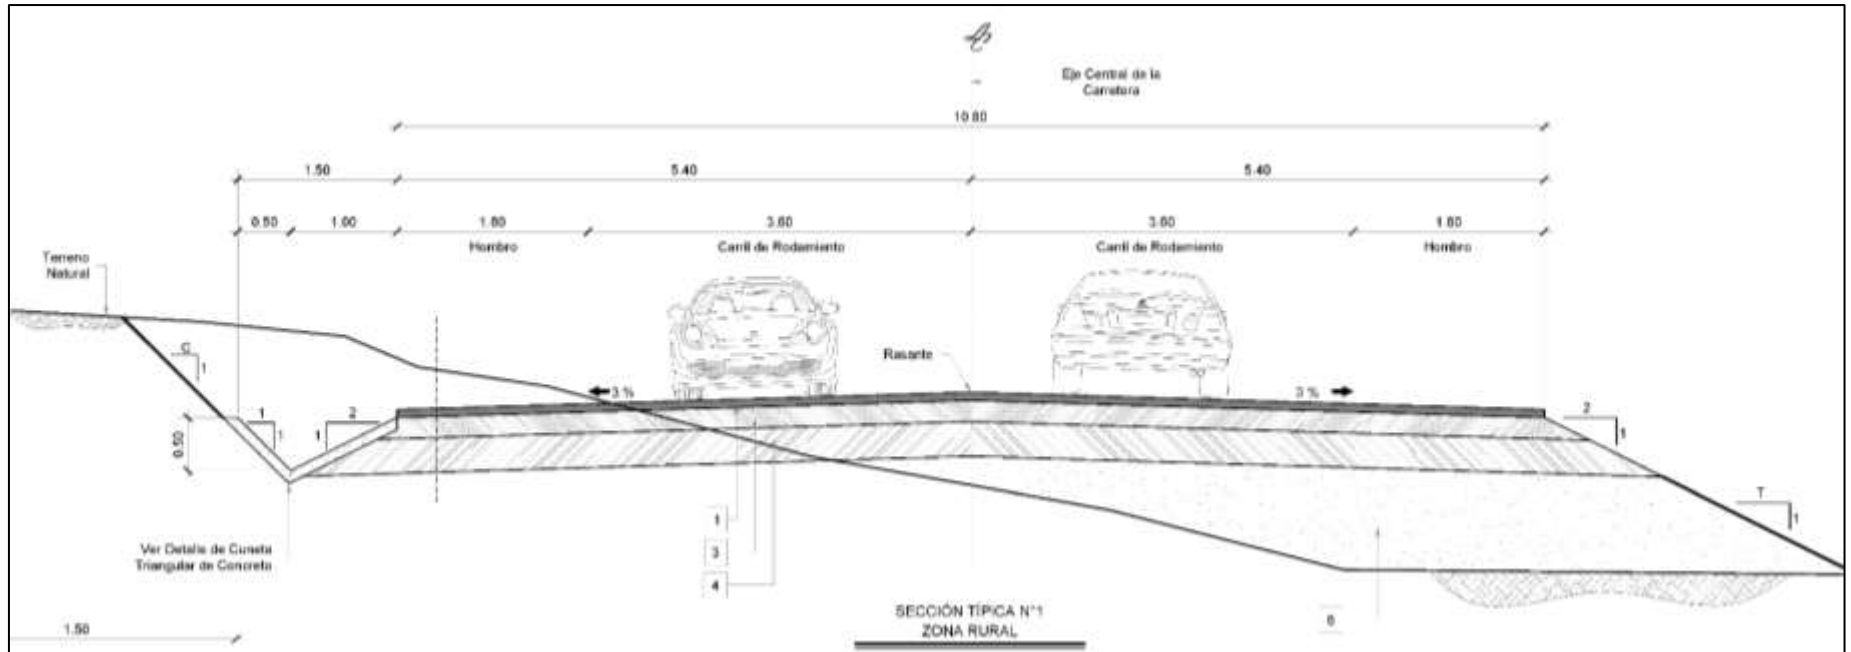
Propuesta de Sección Típica Transversal Zona Rural
